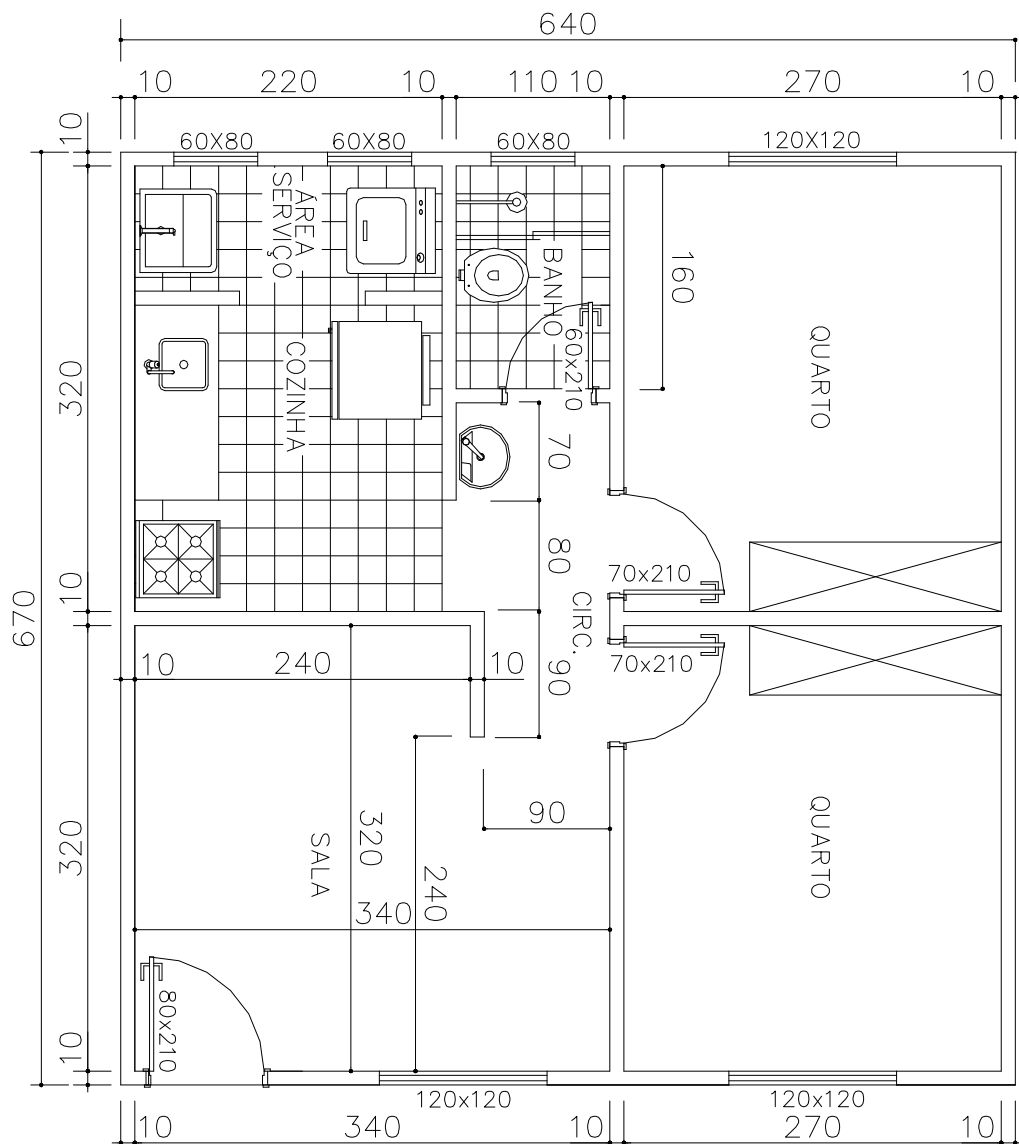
Planta baixa de um apartamento do pavimento tipo do edifício de múltiplos andares.
